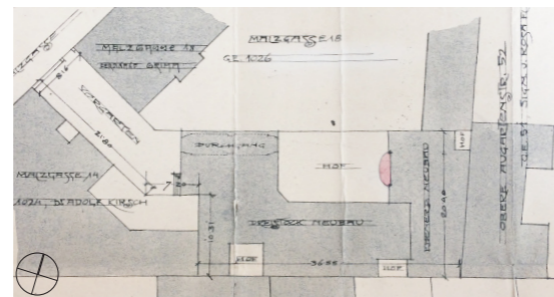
Lageplan Auswechslung (12/1906) [ma37]
